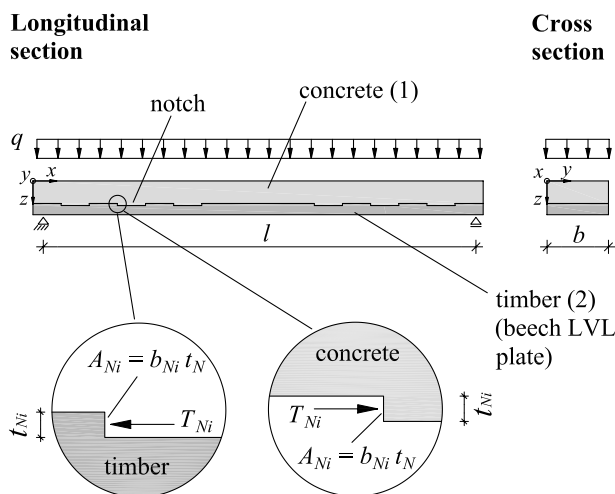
Holz-Beton Verbunddecke aus Buchenfurnierschichtholz mit Kerbverbindungen. Timber-concrete composite member made of a beech LVL plate with a notched connection.
